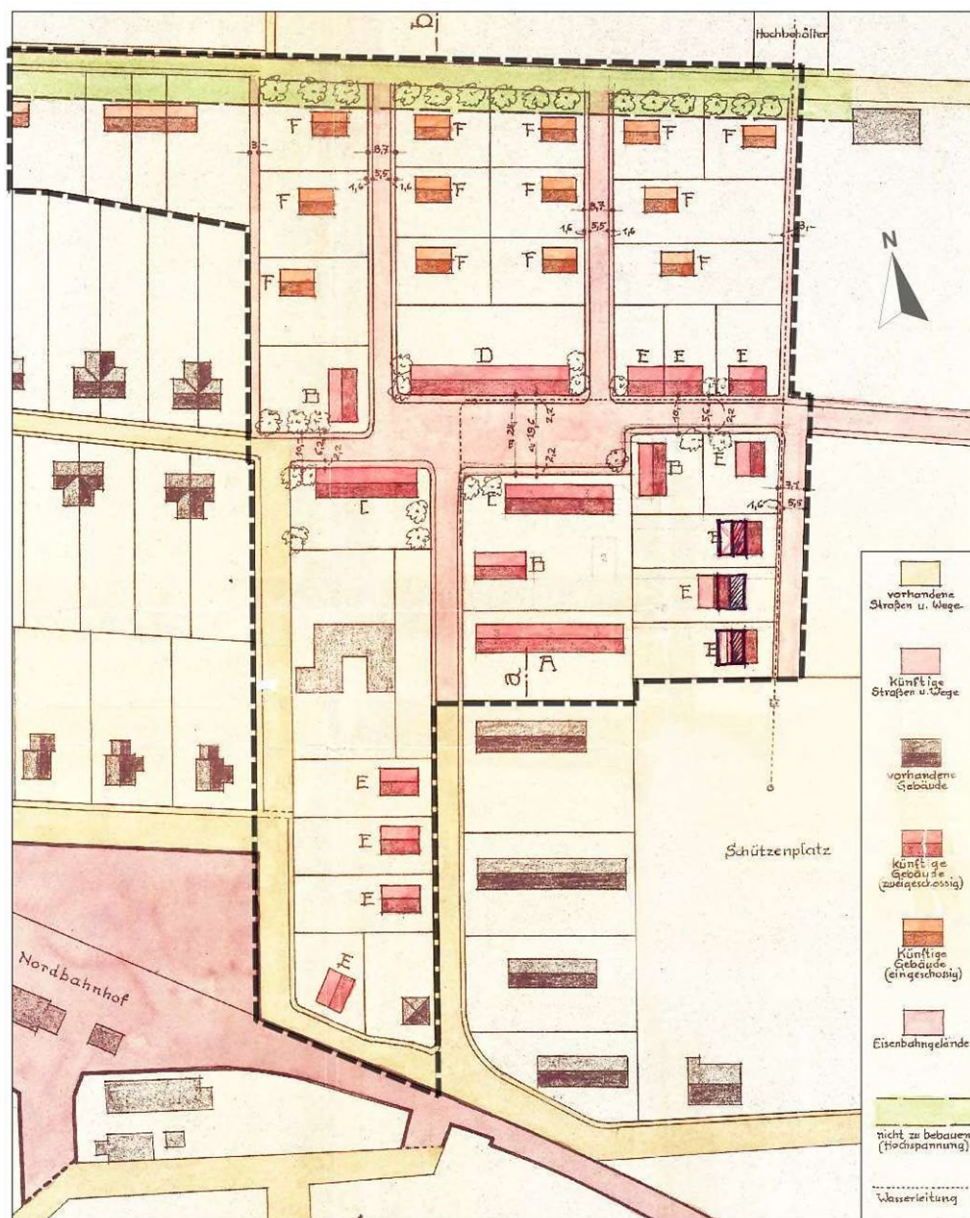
Erschließungs- und Bebauungsplan "Am Schützenplatz", Lageplan (Ausschnitt mit nachträglich markiertem Aufhebungsbereich)
